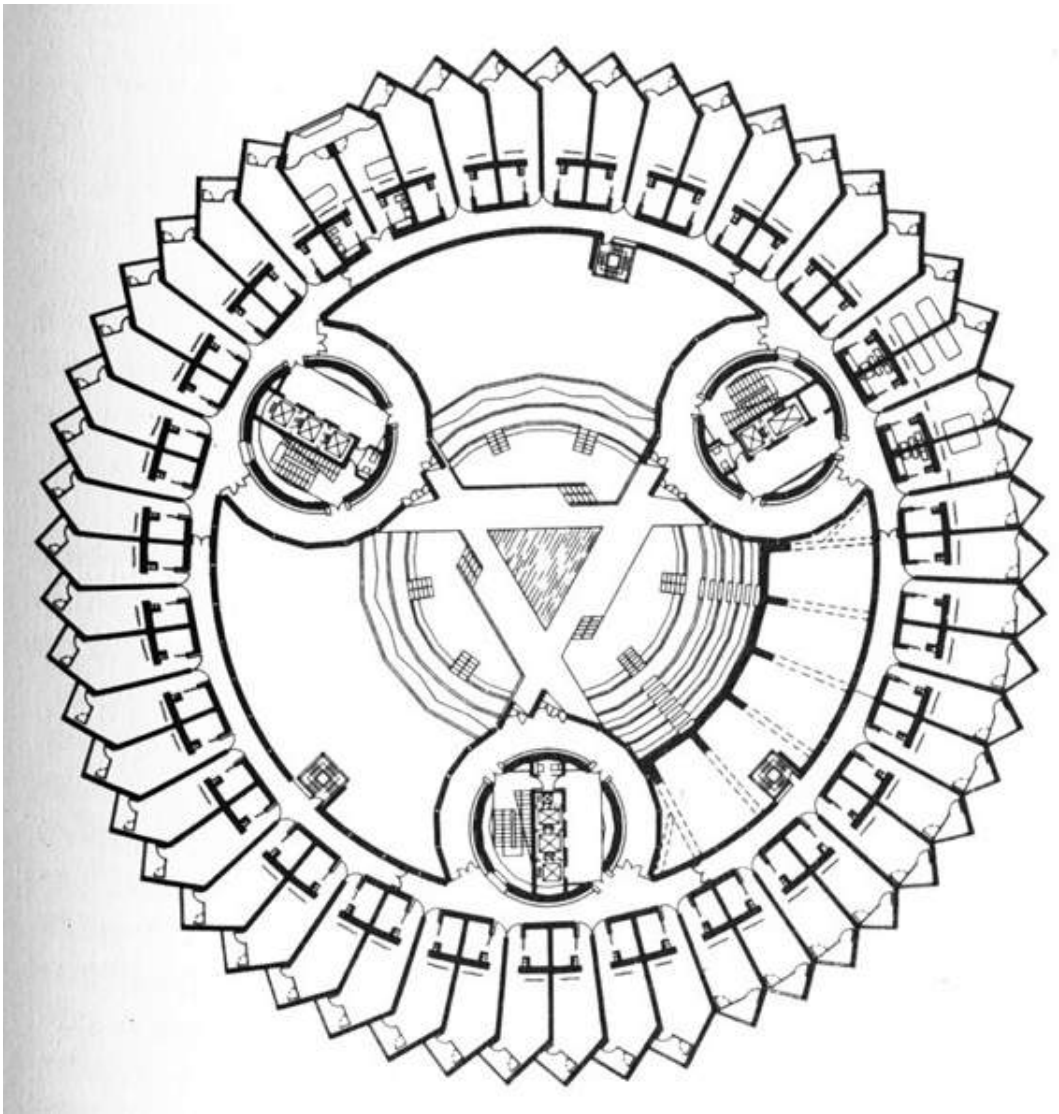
Druzhba Sanatorium, Grundriss Erdgeschoss.
